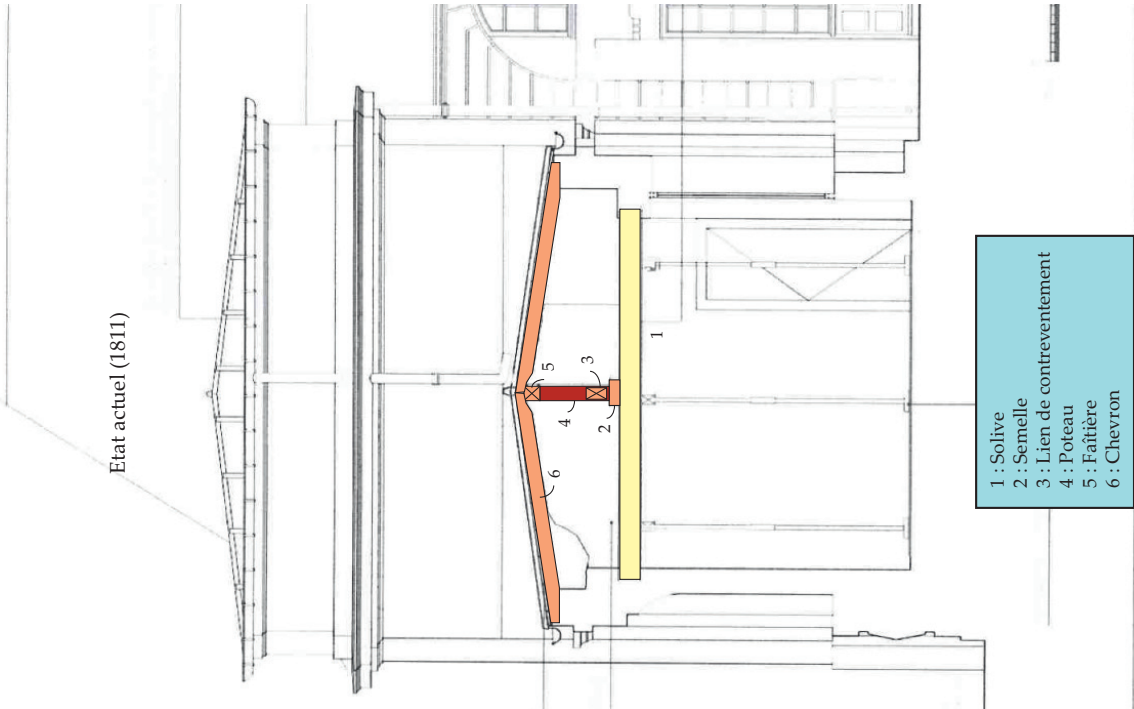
Coupe transversale de l'aile est. Fonds de plan agence Caillault, 2025.
